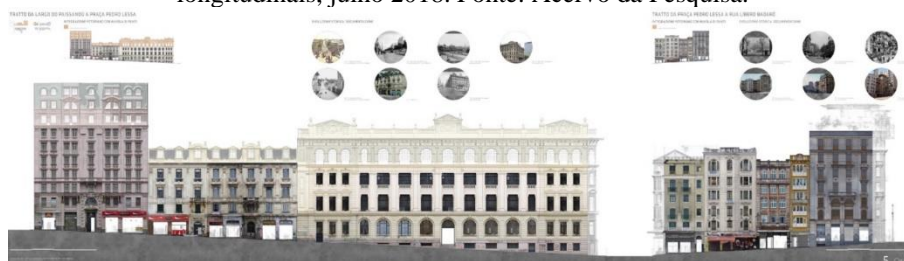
Desenho realizado para a tese de graduação de Anastasia Cottini e Chiara Alessi sob o título: “Avenida São João um rilievo urbano nel centro storico di São Paulo, Brasile”, prancha 5, tratamento das fachadas entre o Largo Paissandú e a Rua Líbero Badaró, julho 2018. Fonte: Acervo da Pesquisa.
